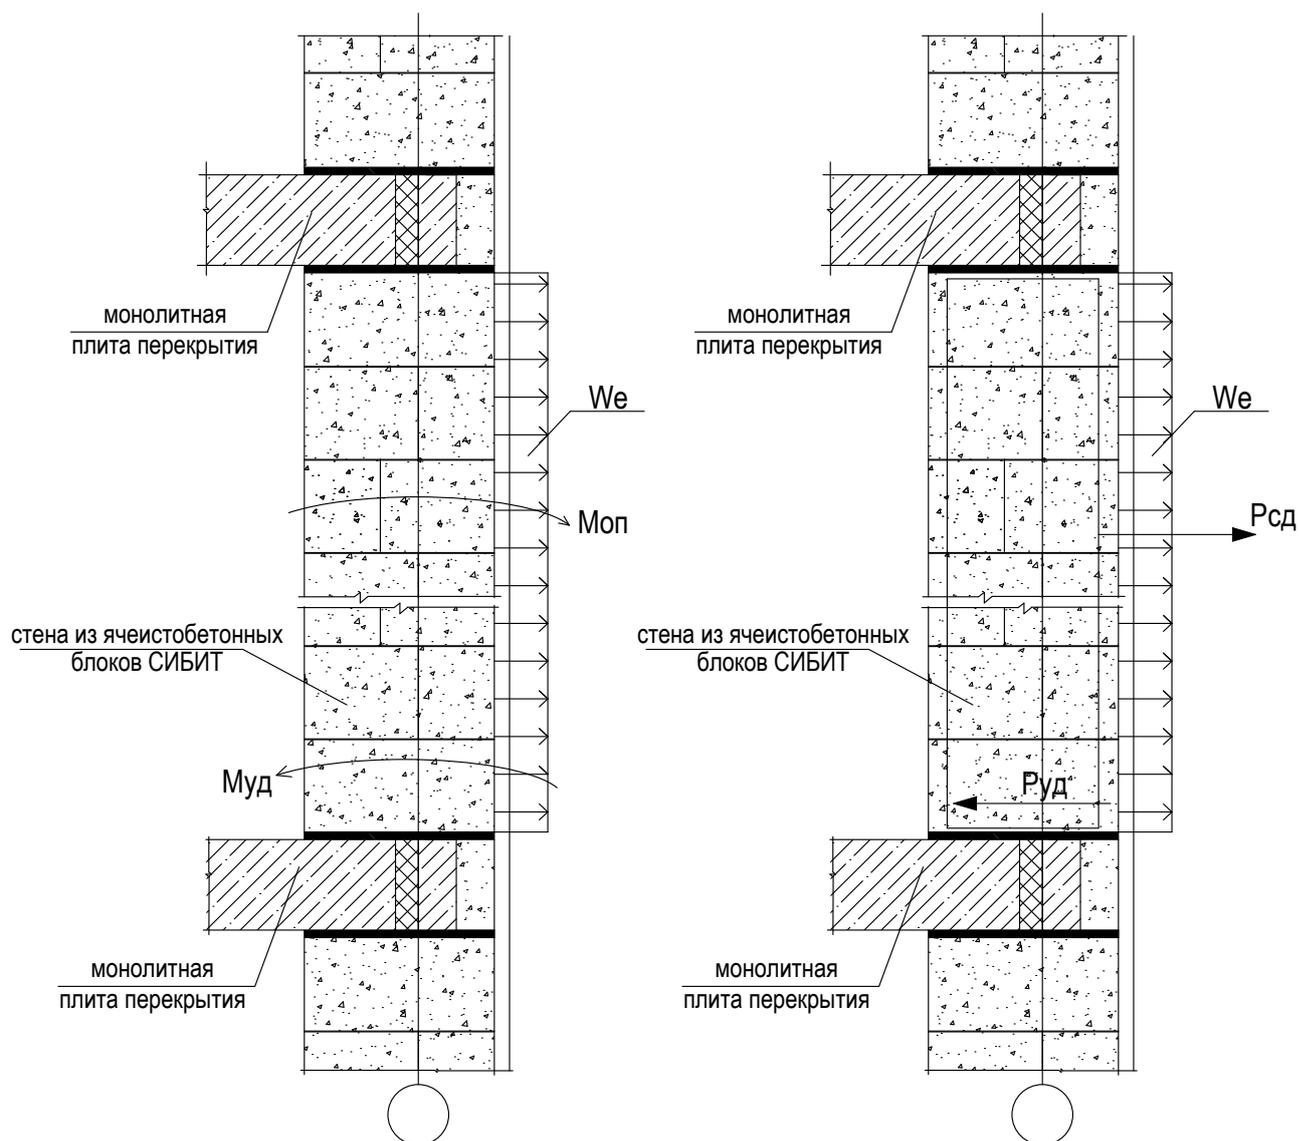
Расчетные схемы поэтажно опертых наружных стен на ветровое воздействие
